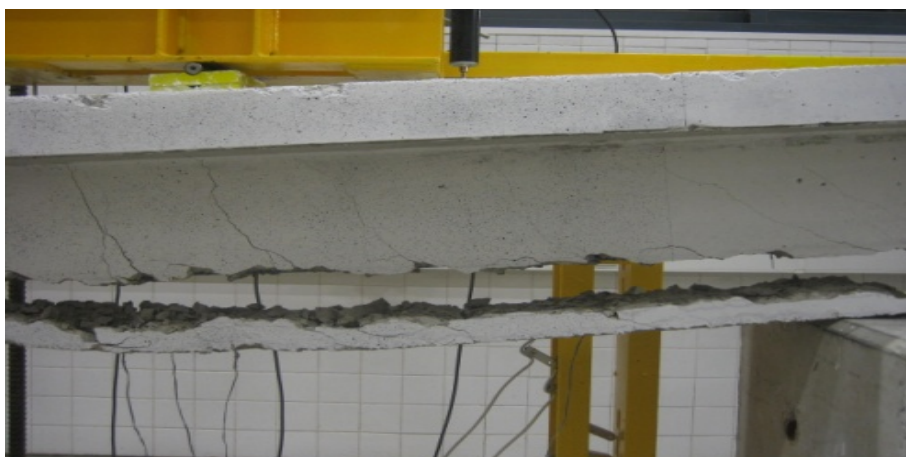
Pormenor da deformação e da fissuração da viga TSC4 (NSMR) junto a uma das zonas de aplicação da carga
